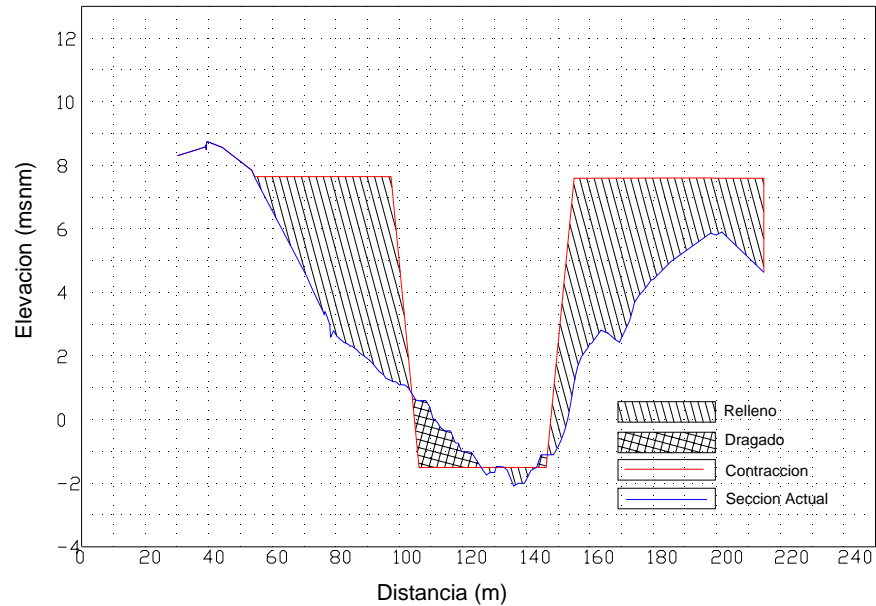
Sección transversal km 1 - Contracción No. 1
